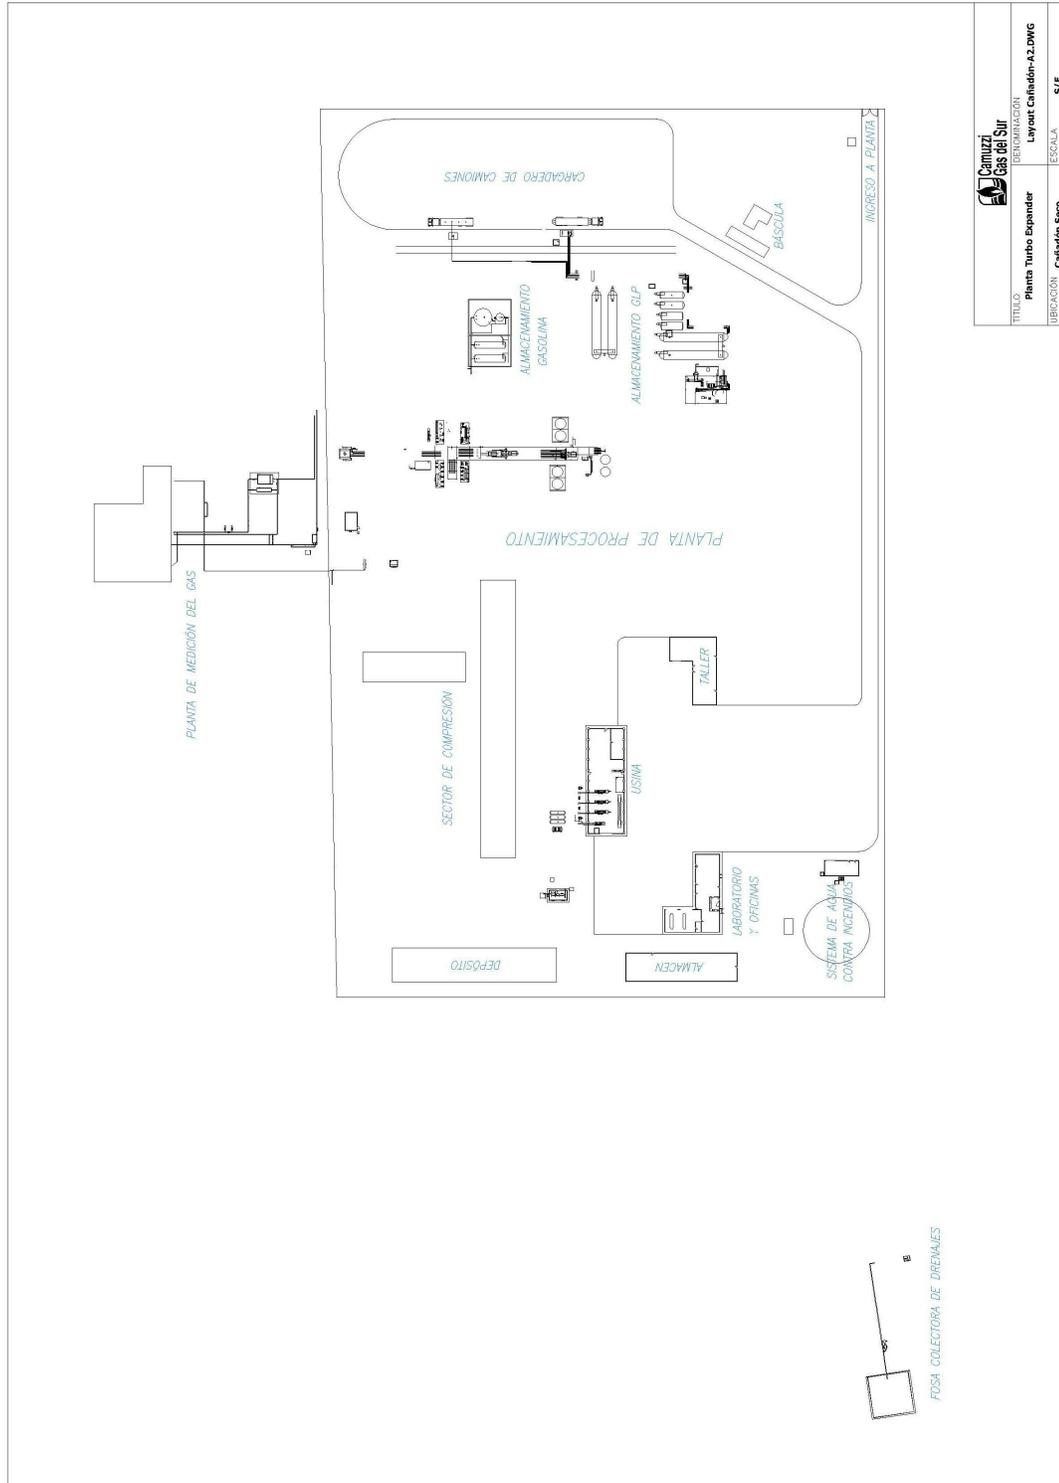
Layout de la planta de Cañadón Seco, con la alternativa 2.
